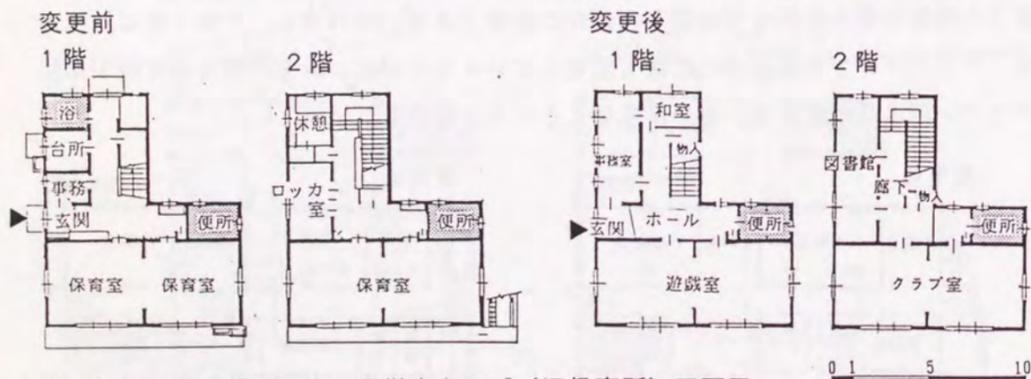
<44>渋谷区富ヶ谷学童クラブ(旧保育所)平面図
